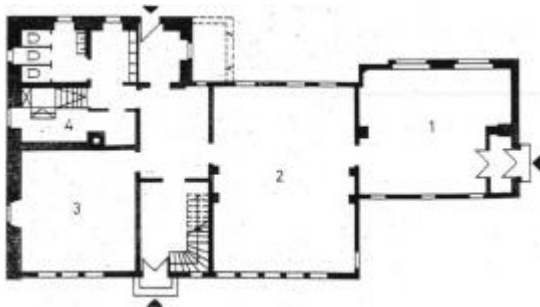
Grundriß Erdgeschoß des Fröbelhaus ²
